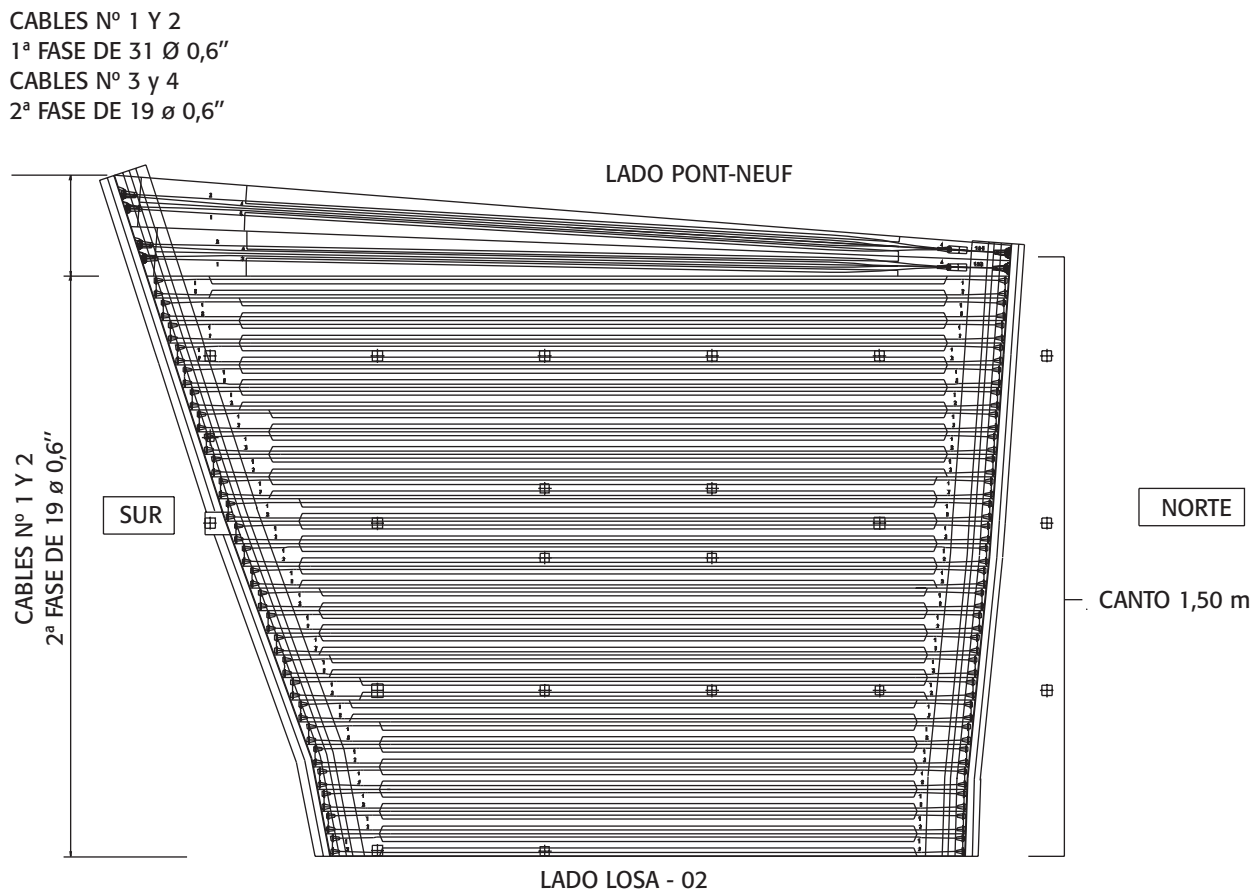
Pretensado longitudinal de la losa 1 en dos fases; antes y después de construir los edificios
